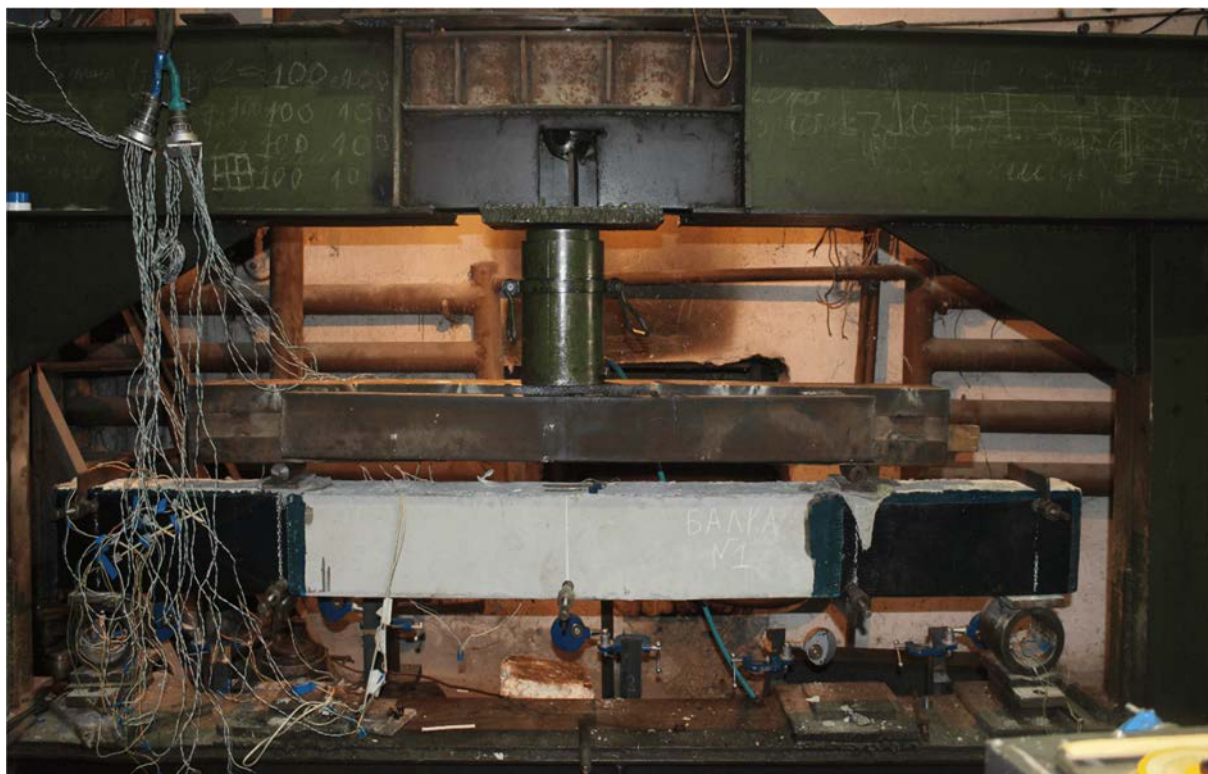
Общий вид статических испытаний железобетонных балок
